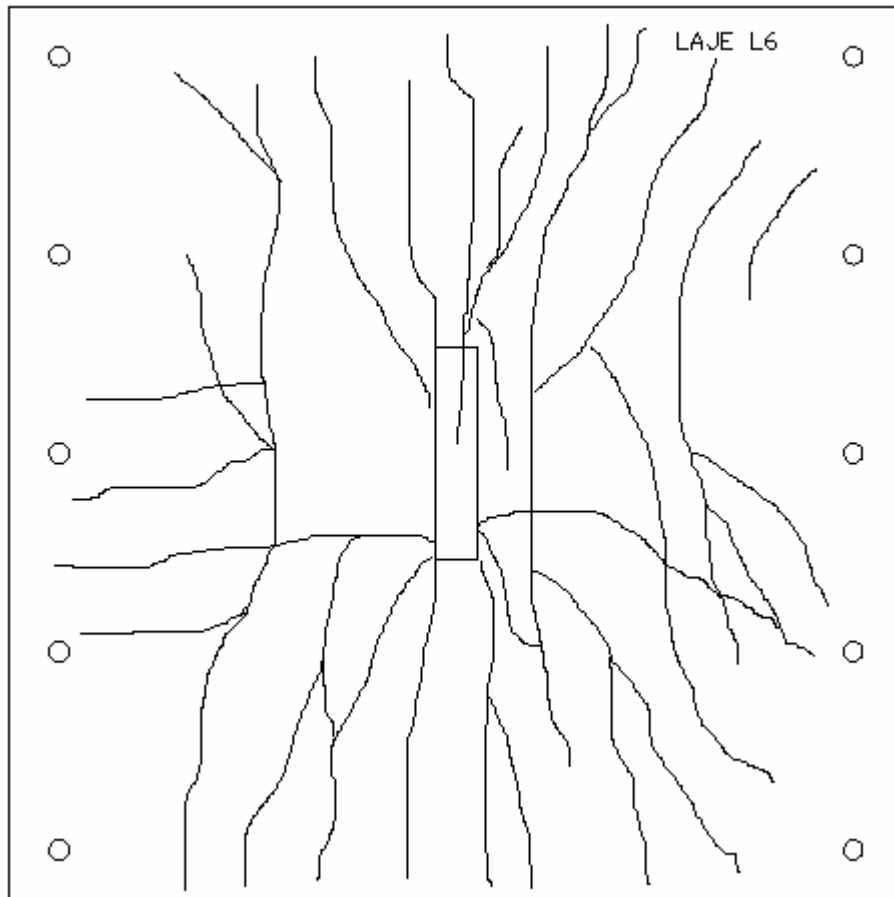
Mapa de fissuração da laje L6
